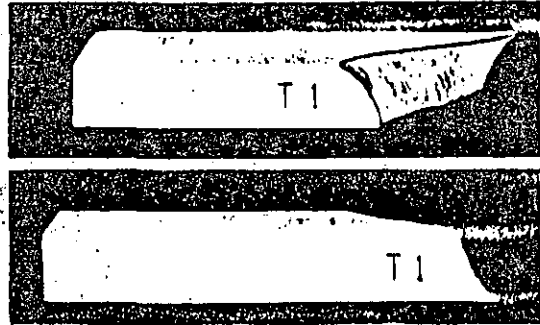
Viga de mortero simple en torsión pura (a) Vista superior; (b) Vista inferior
